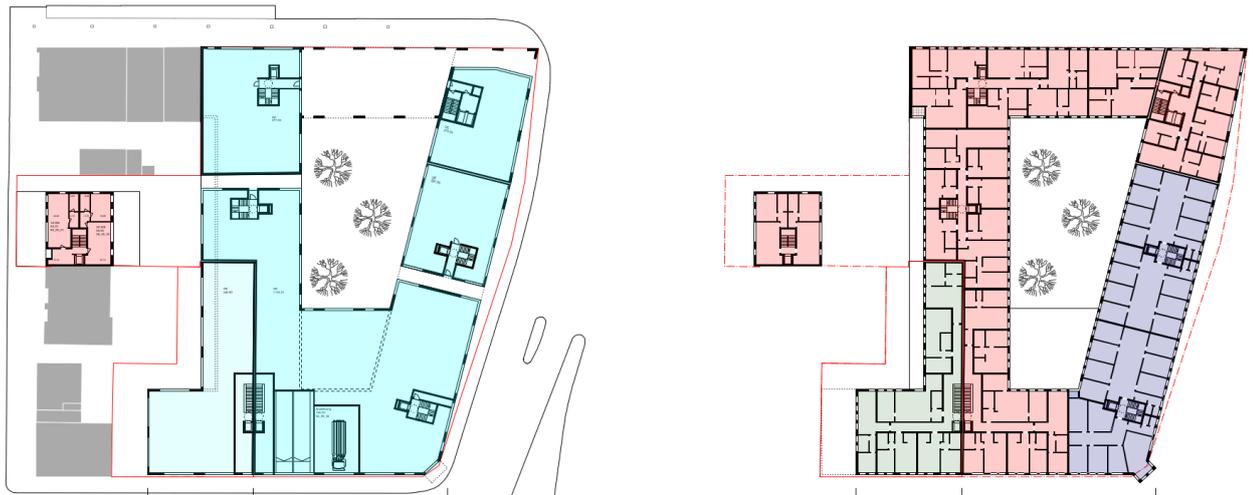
und 10: Lageplan EG (links) und 1. OG (rechts) – Überarbeitung Entwurf Preisträger, März 2020 (ohne Maßstab, Quelle: Tilman Probst Architekten, München)
